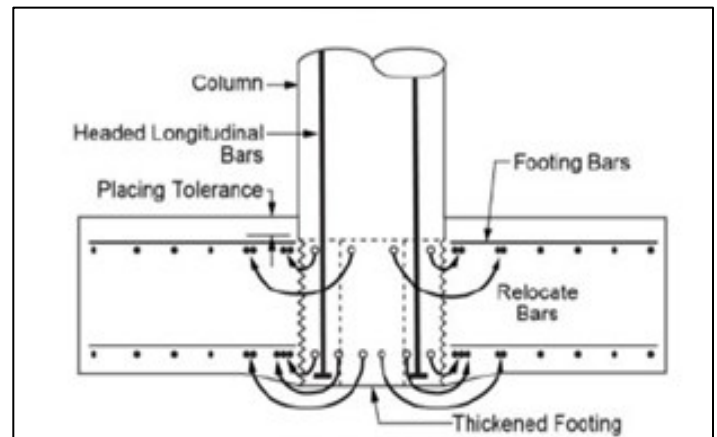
Conexión Columna Zapata. Fuente: *AASHTO LRFD GSABC* (2018).
